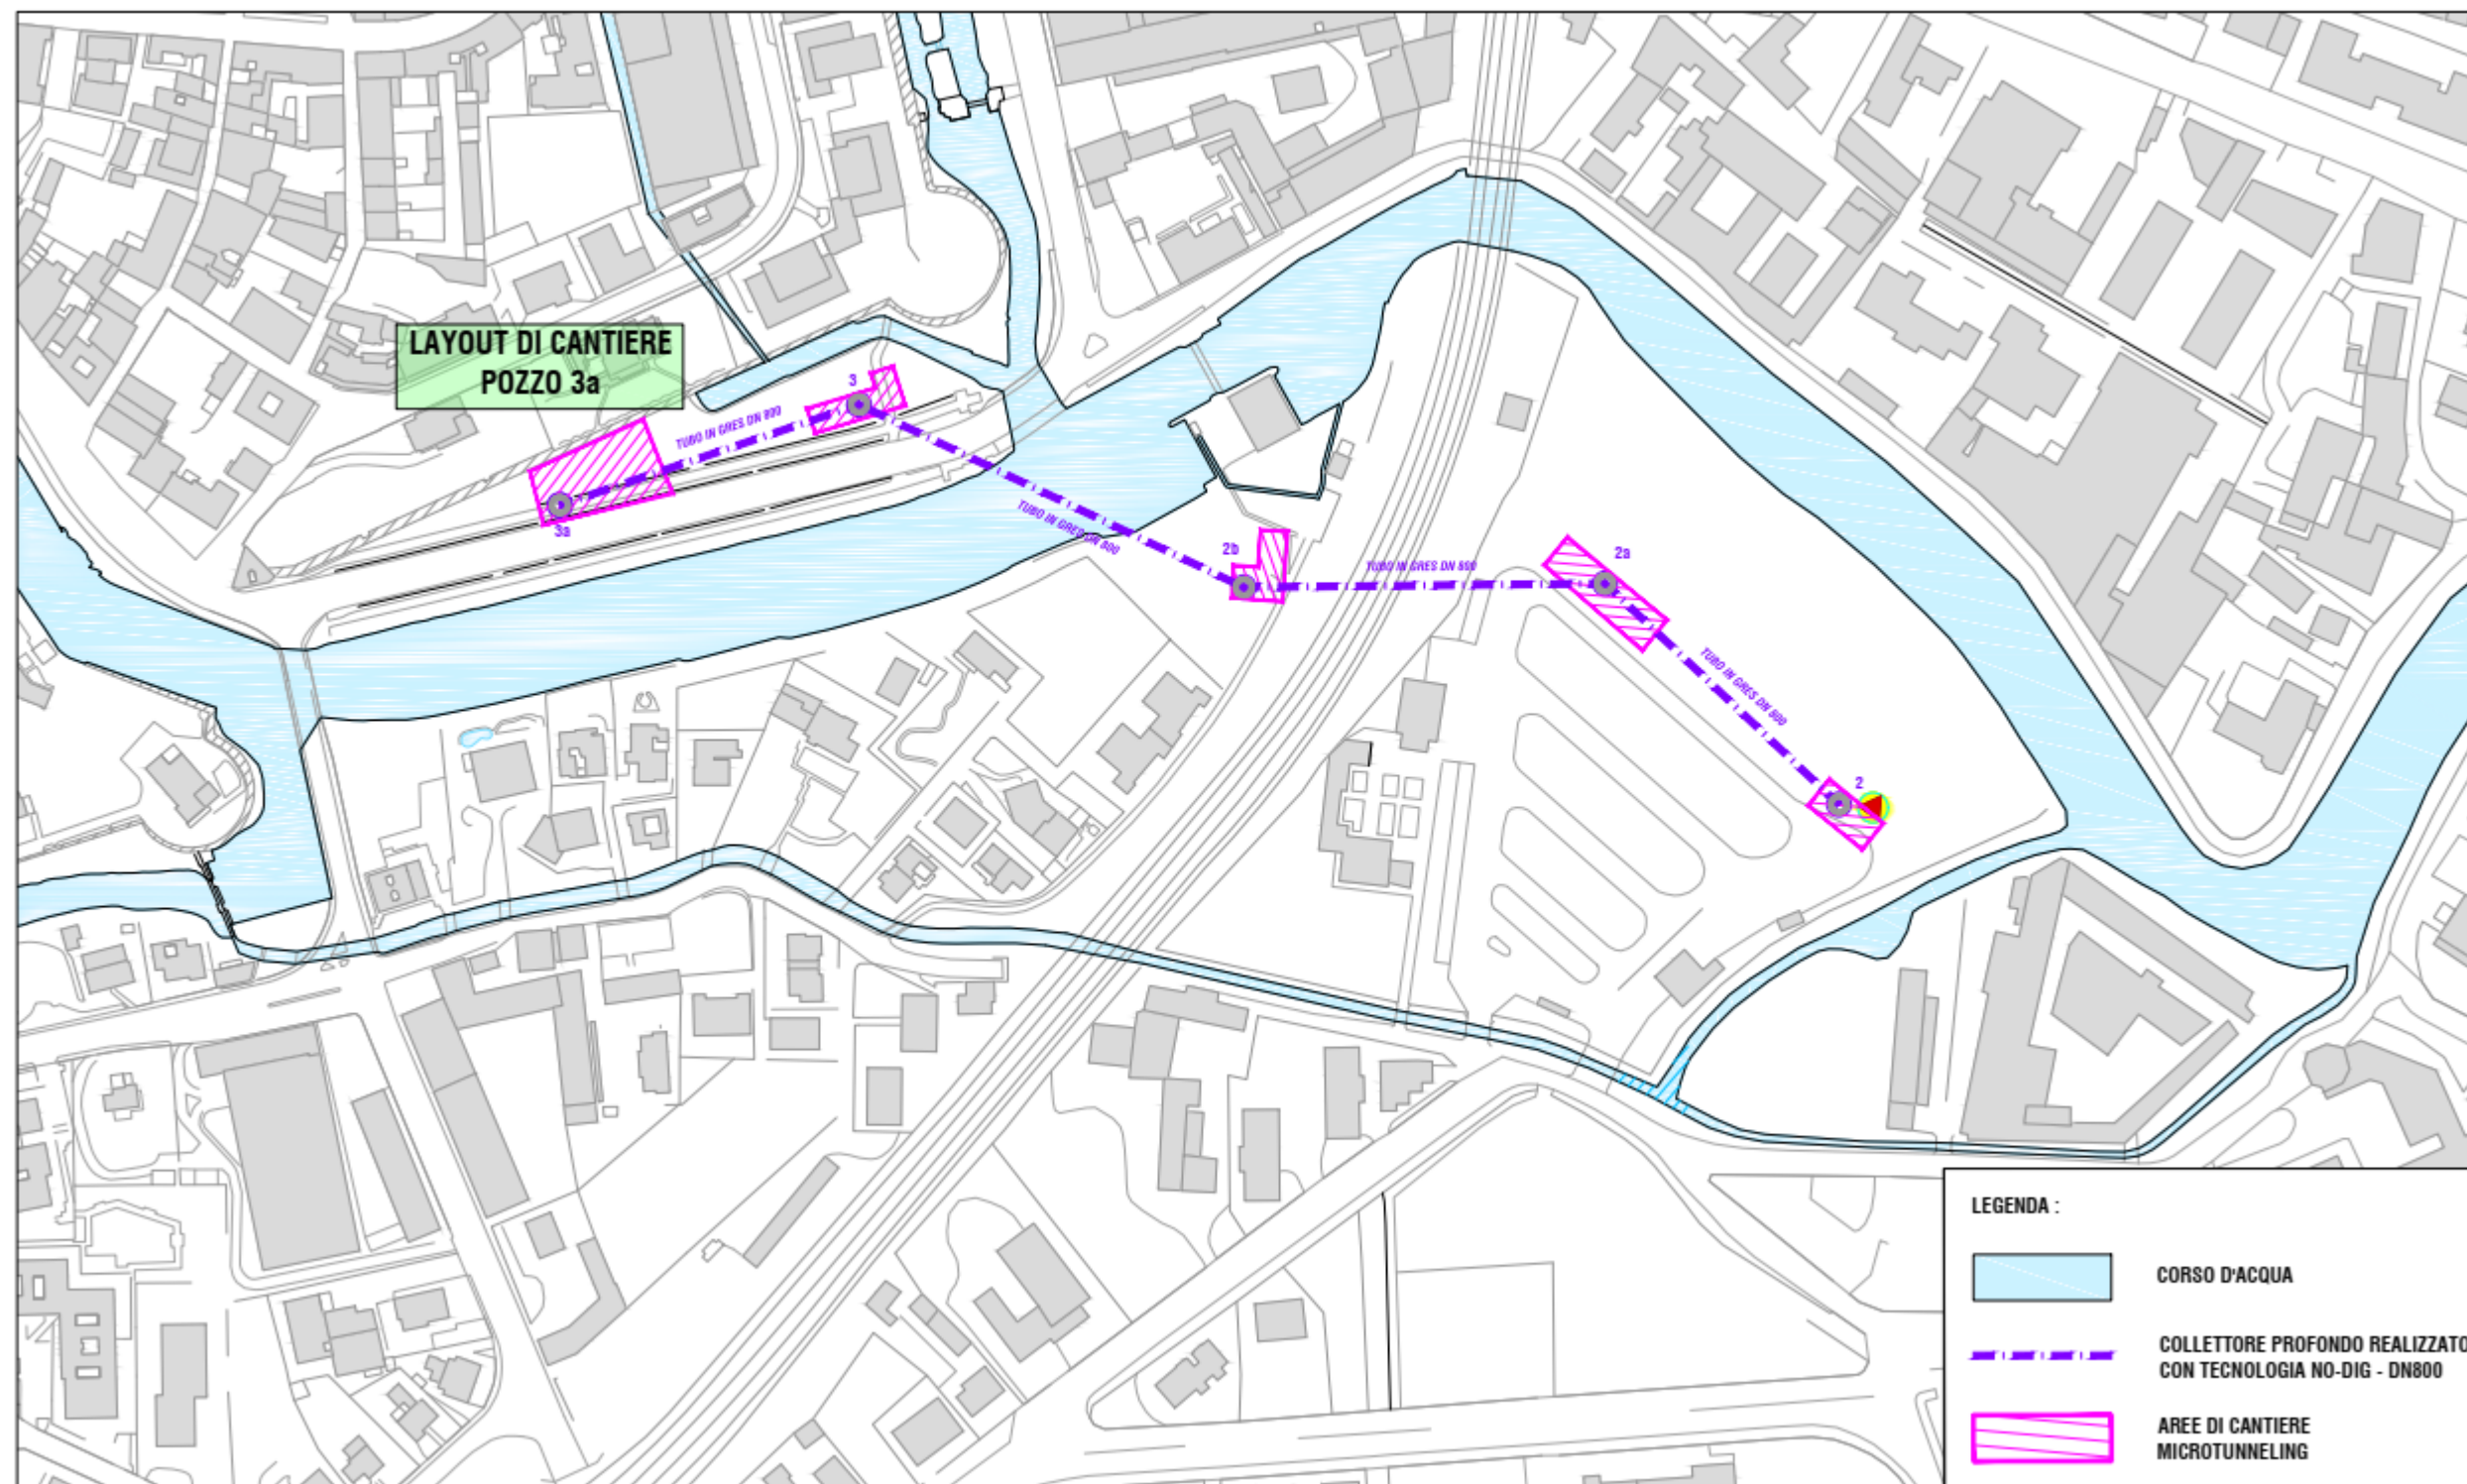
A : Inquadramento planimetrico area cantiere POZZO S03a
